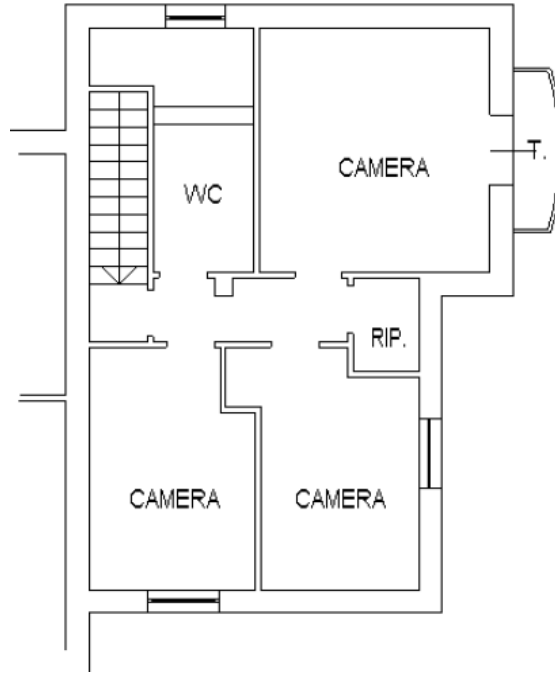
Estratto della planimetria catastale – sub. 2, p.p.
